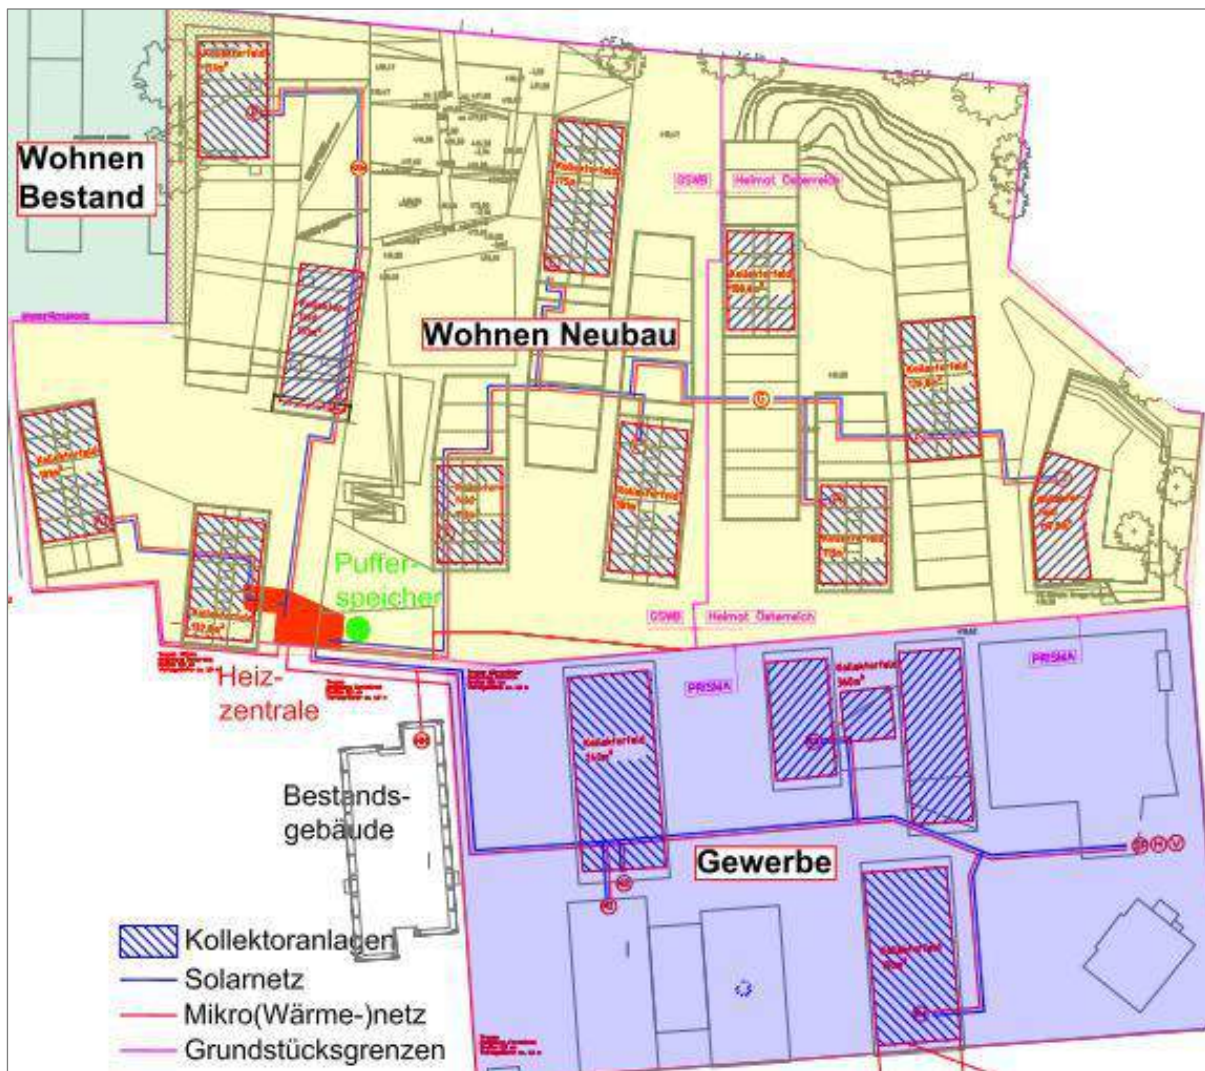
Lageplan der Anlage „Salzburg Lehen“. Bildquelle: Salzburg AG
